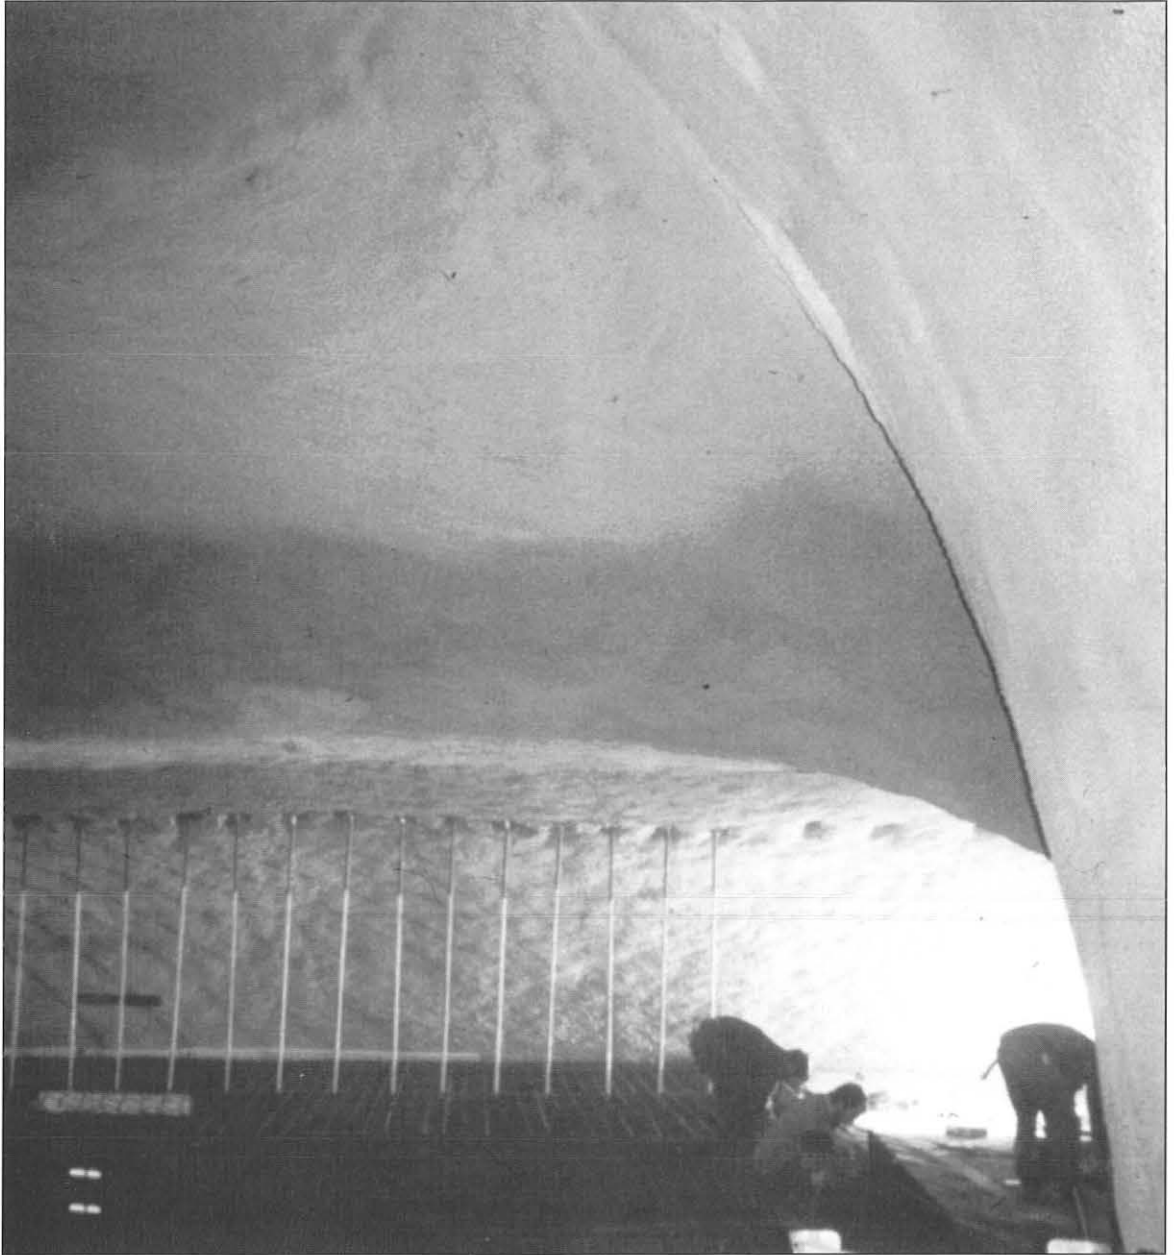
Spritzbeton mit seiner rauhen Struktur als gestalterisches Element
